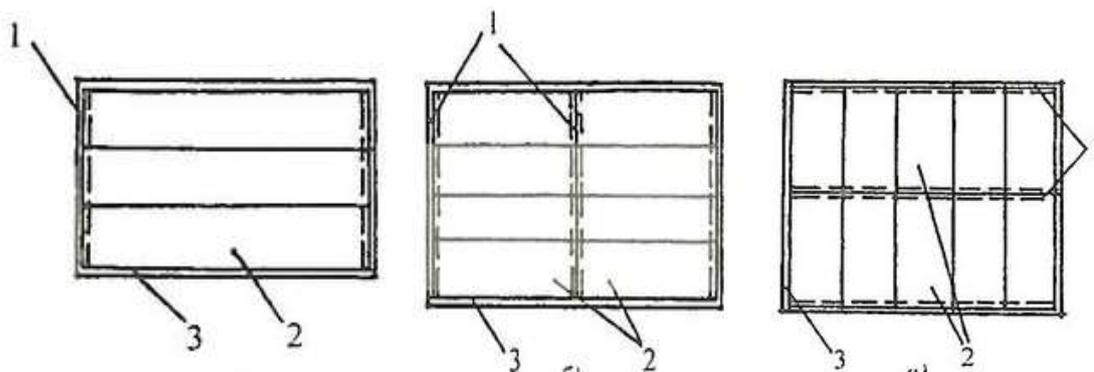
Бескаркасные конструктивные схемы: а, б, — с поперечным расположением несущих стен; в — с продольным расположением стен, 1 — несущая стена; 2 — плита перекрытия; 3 — самонесущая стена
